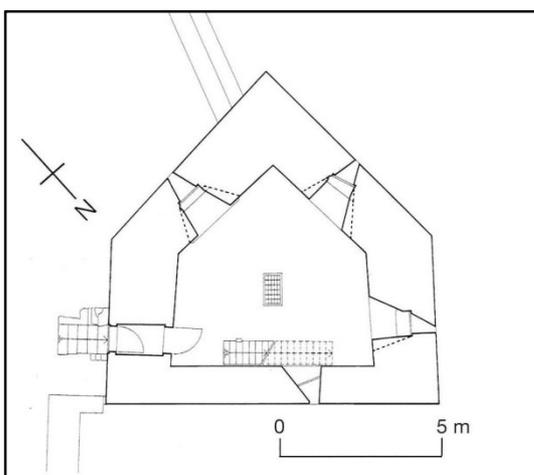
Grundriss auf Höhe des Erdgeschosses
